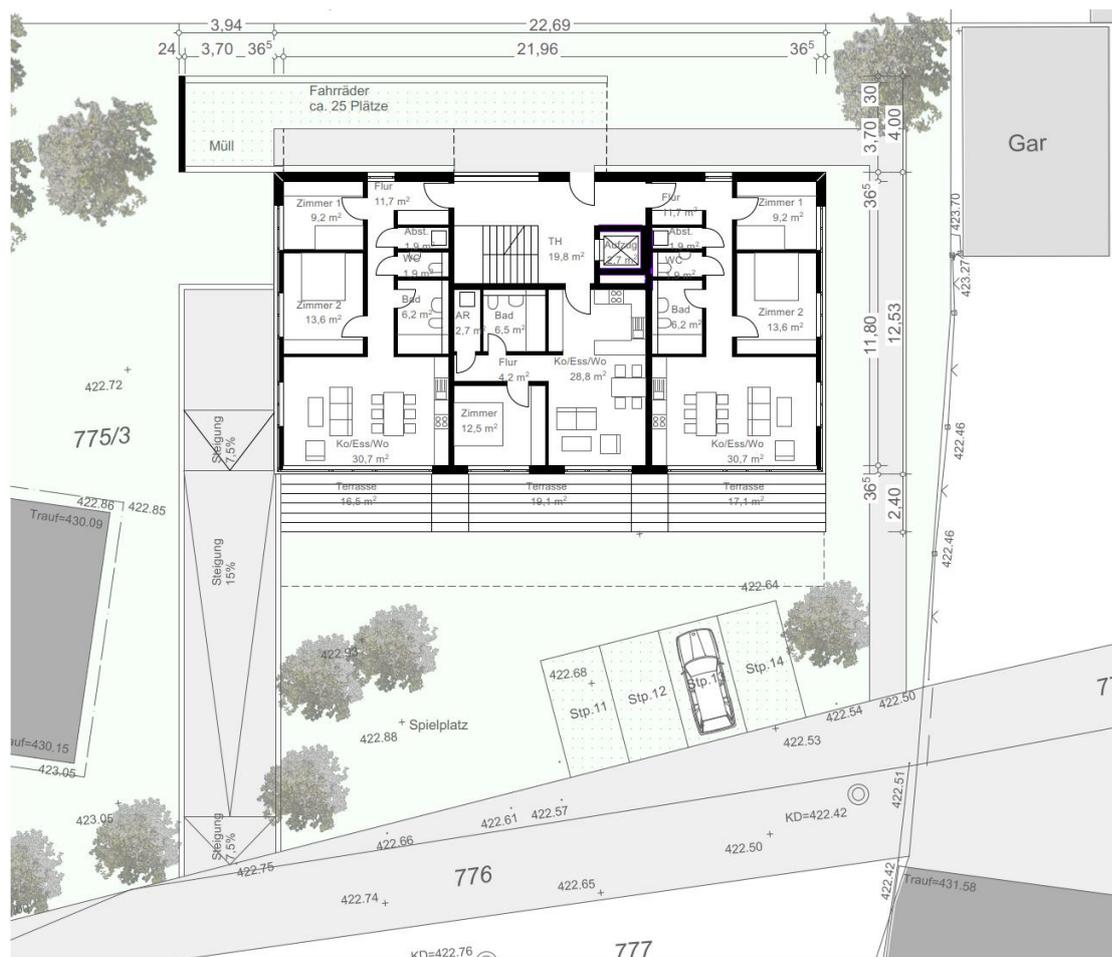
Übersicht Grundriss EG Achim Sauer, Freier Architekt
